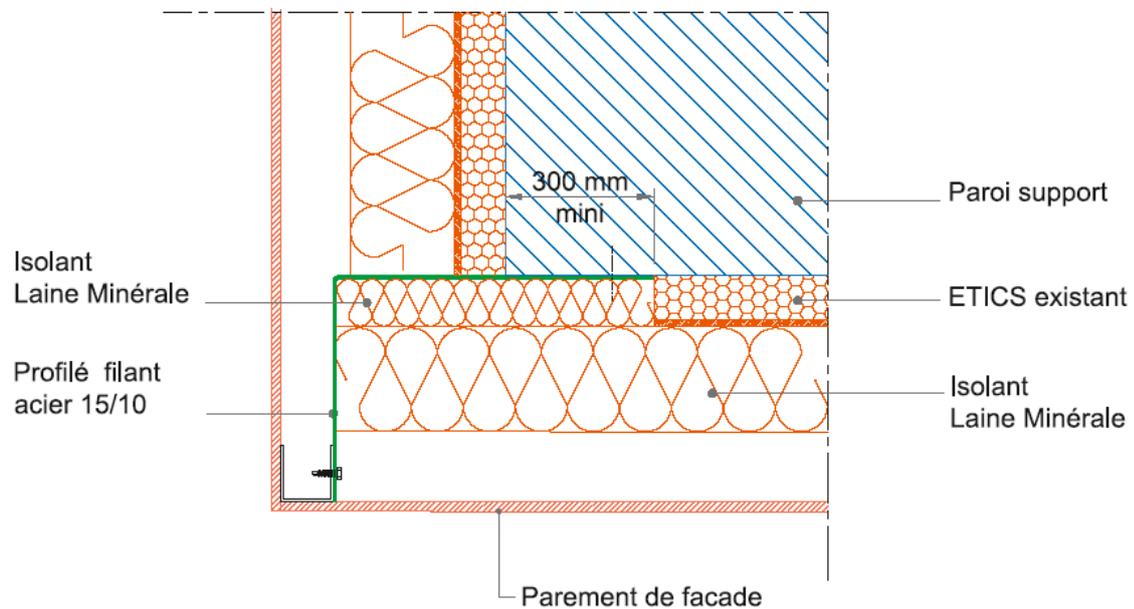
Coupe horizontale du recouplement vertical toute hauteur de la façade
